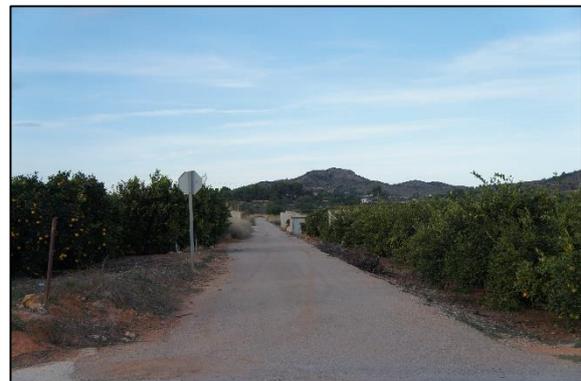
Camino sin pavimentar que atraviesa el Sector I-11
